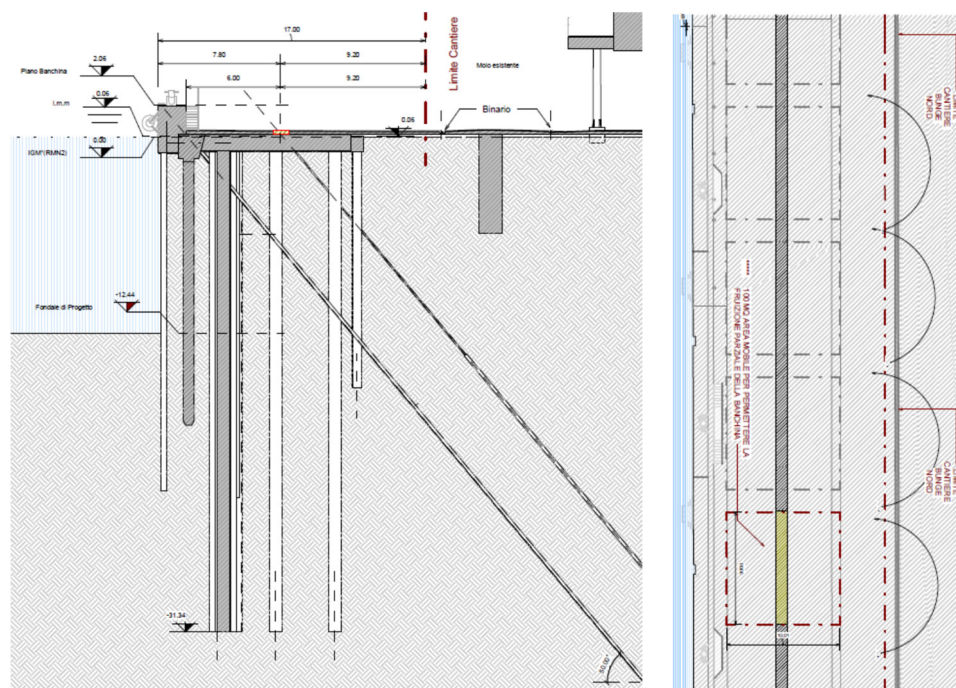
Banchina Bunge Nord – Fase 1 – Sezione e planimetria
